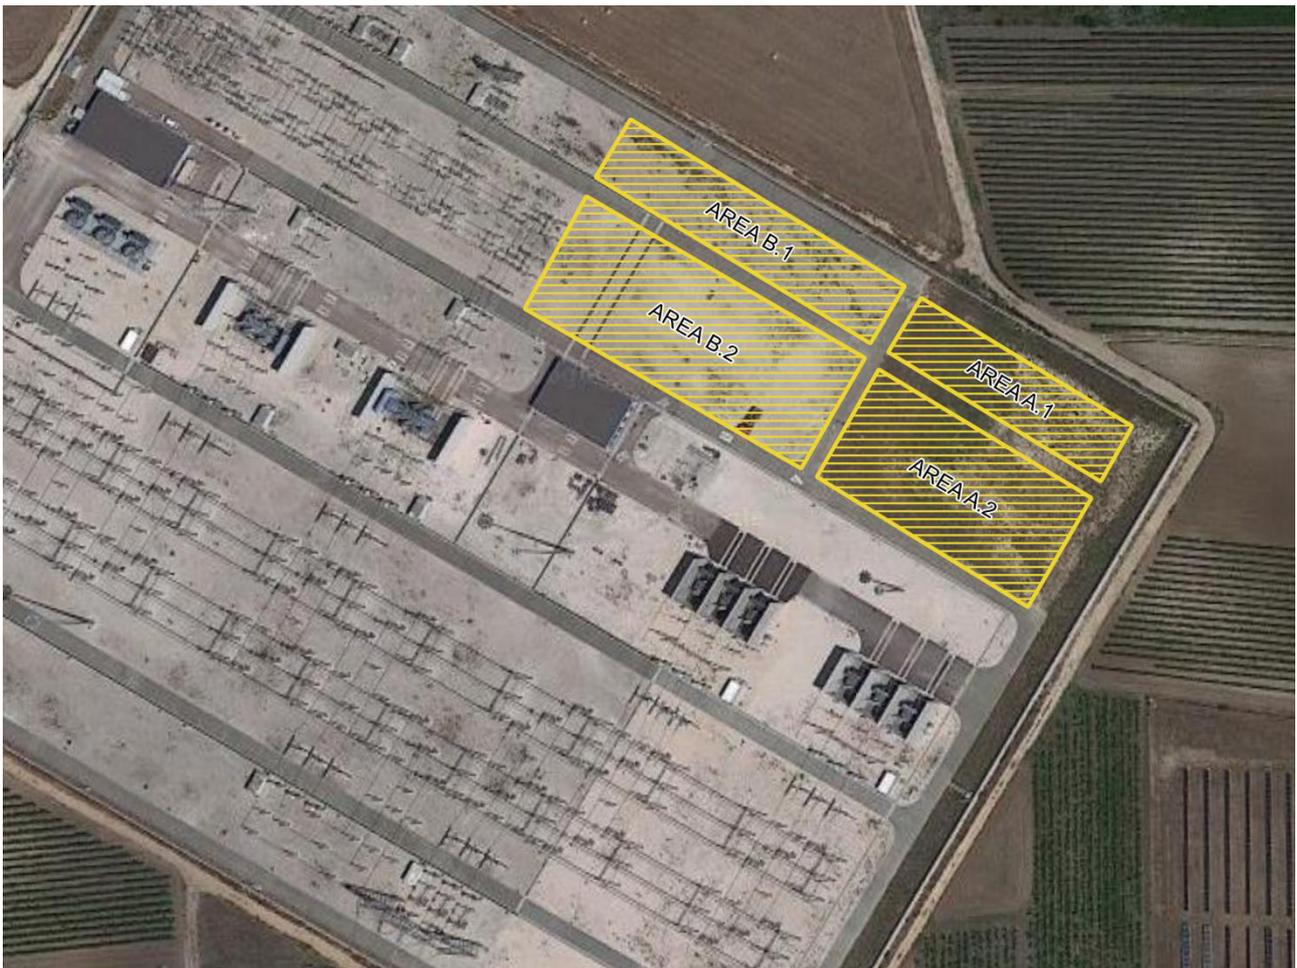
| Aree di scavo nell'area oggetto di intervento.
